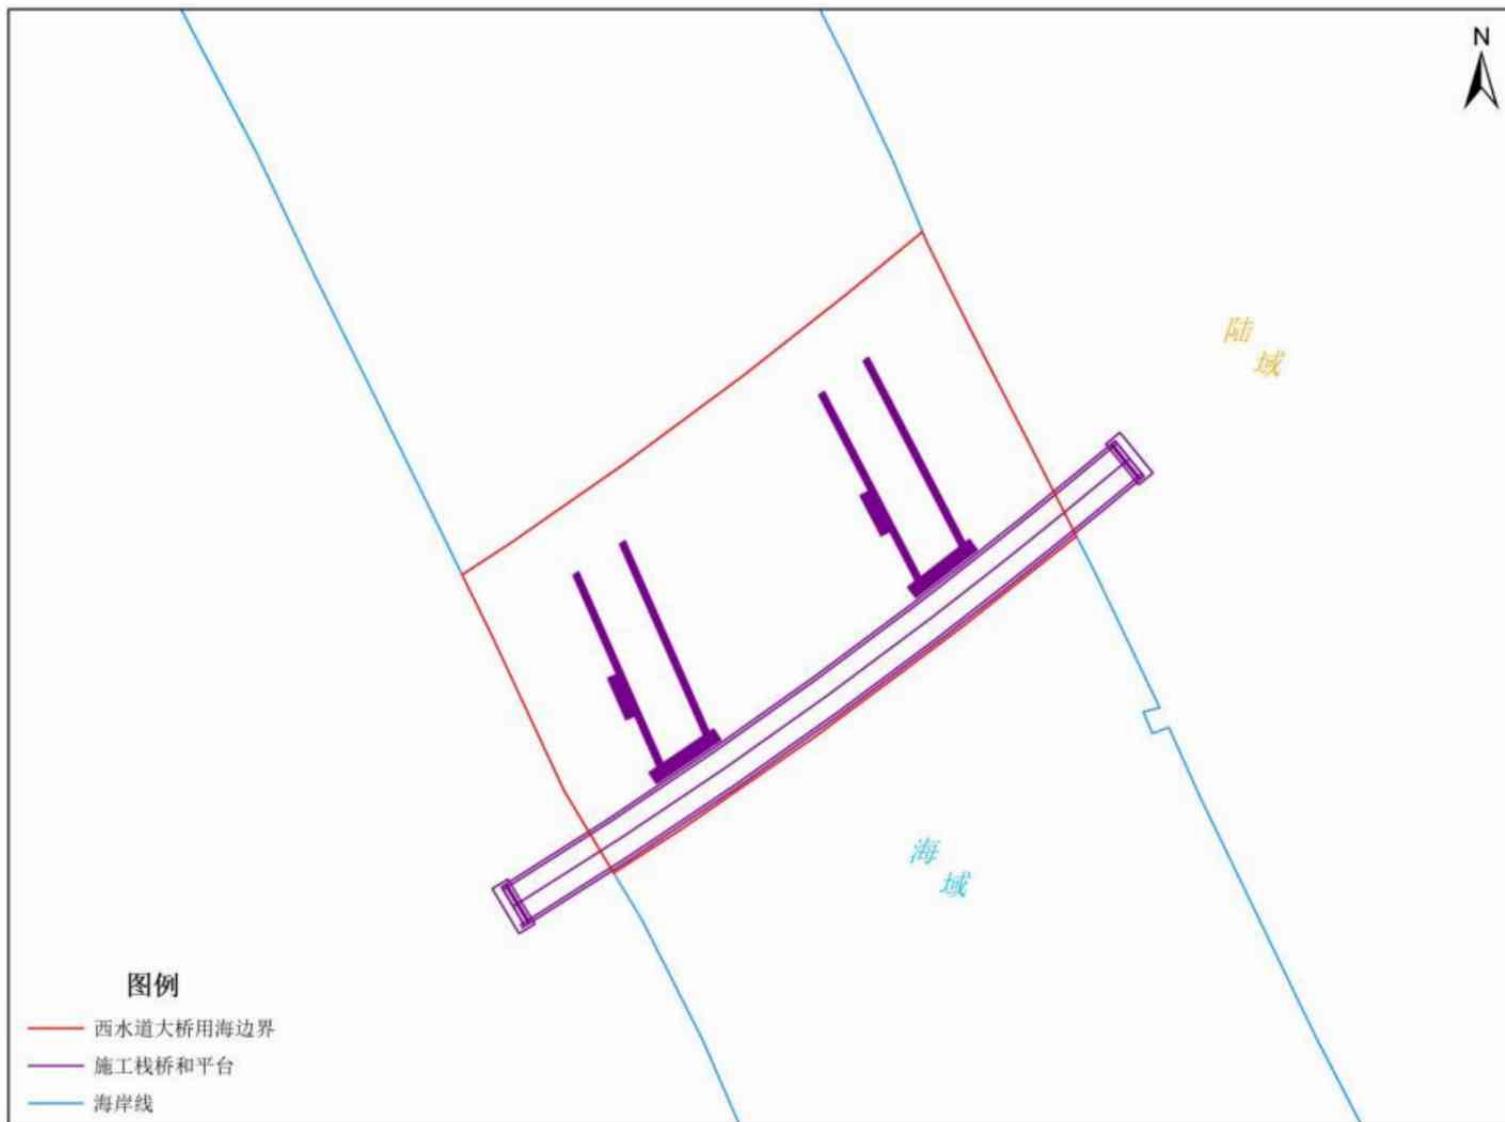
西水道大桥用海与施工栈桥位置示意图
